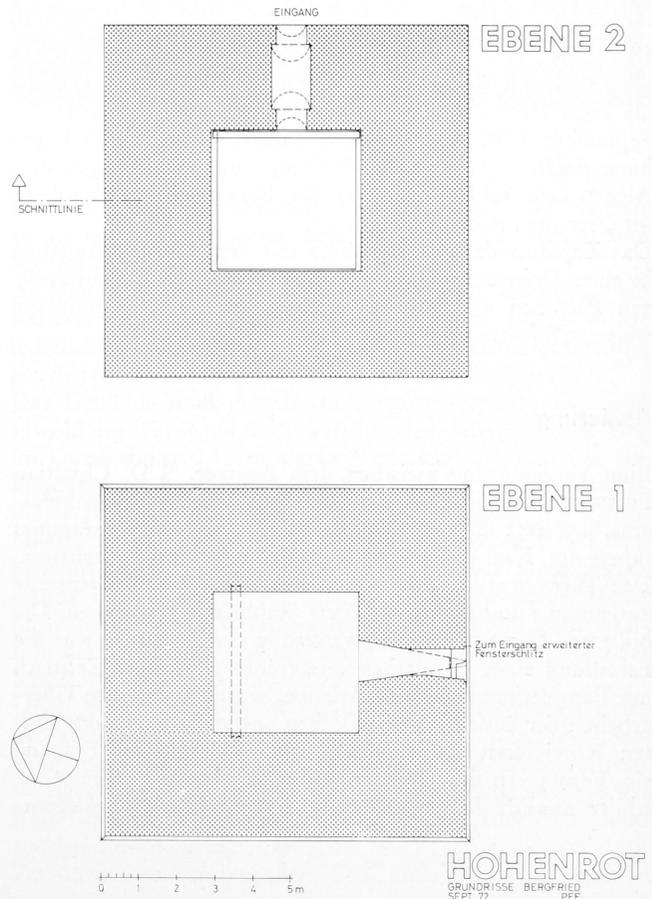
Rötterturm. Grundrisse, September 1972
